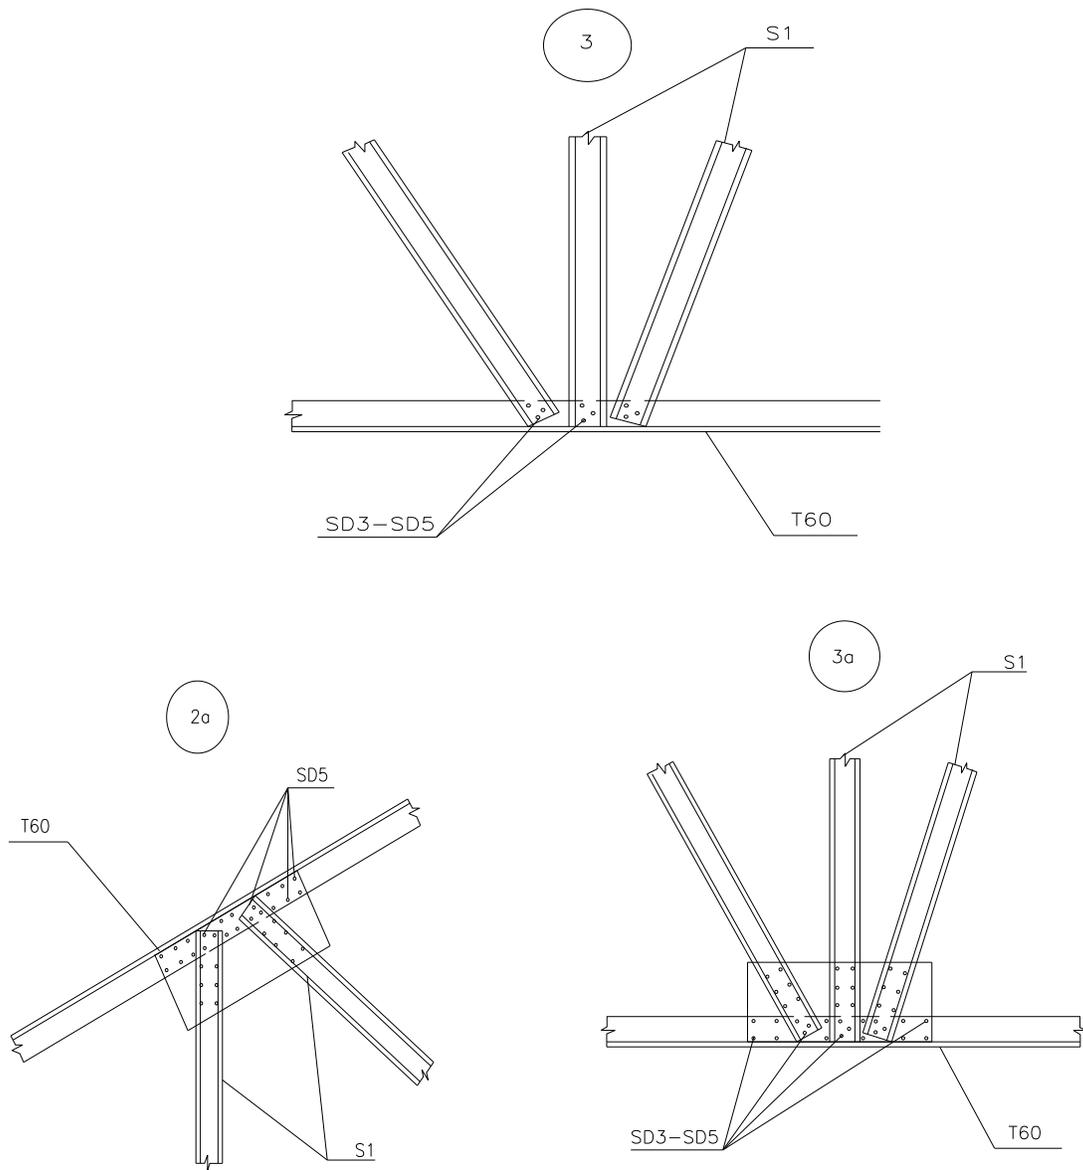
Узлы крепления верхних и нижних раскосов/стоек стропильных ферм.
